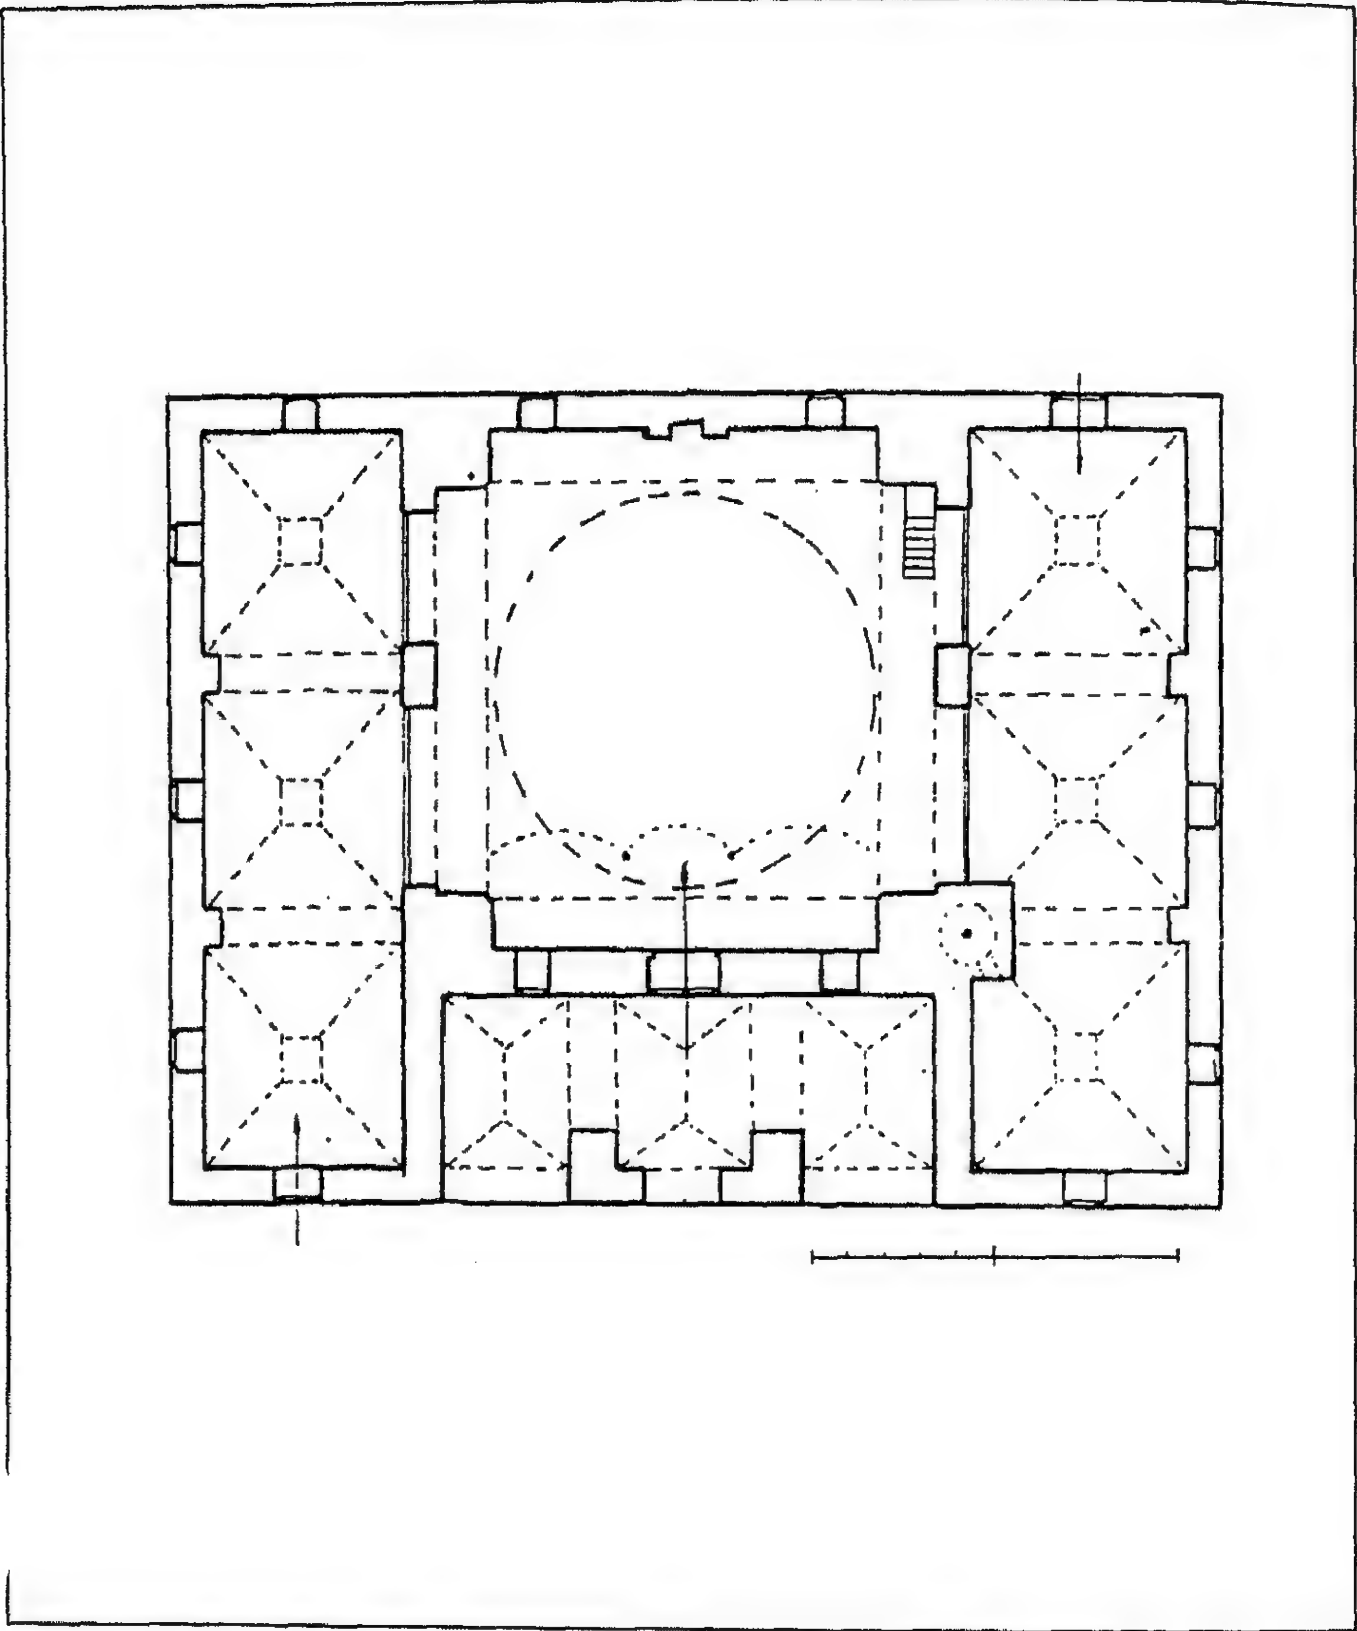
مسقط أفقي لمسجد السوق في Gjirokastër (عن : كيل) .
